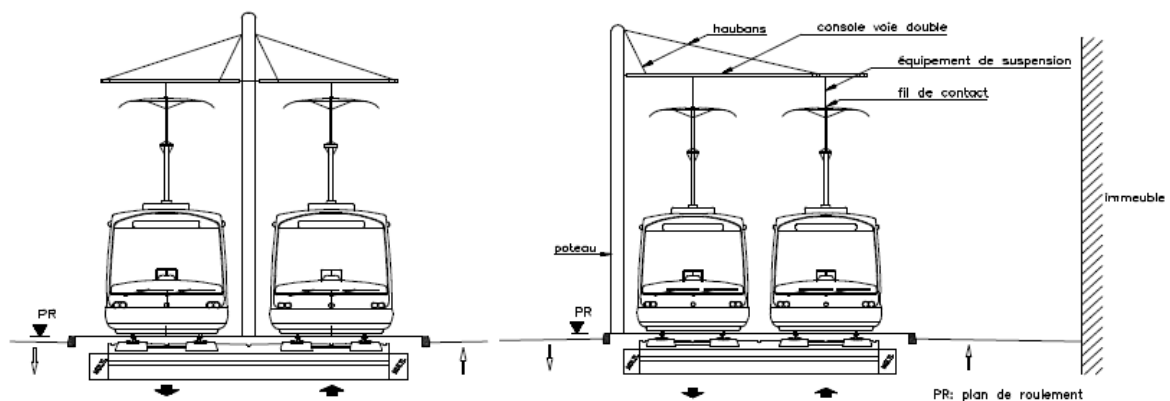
LAC avec poteau central (à gauche) et latéral (à droite)
